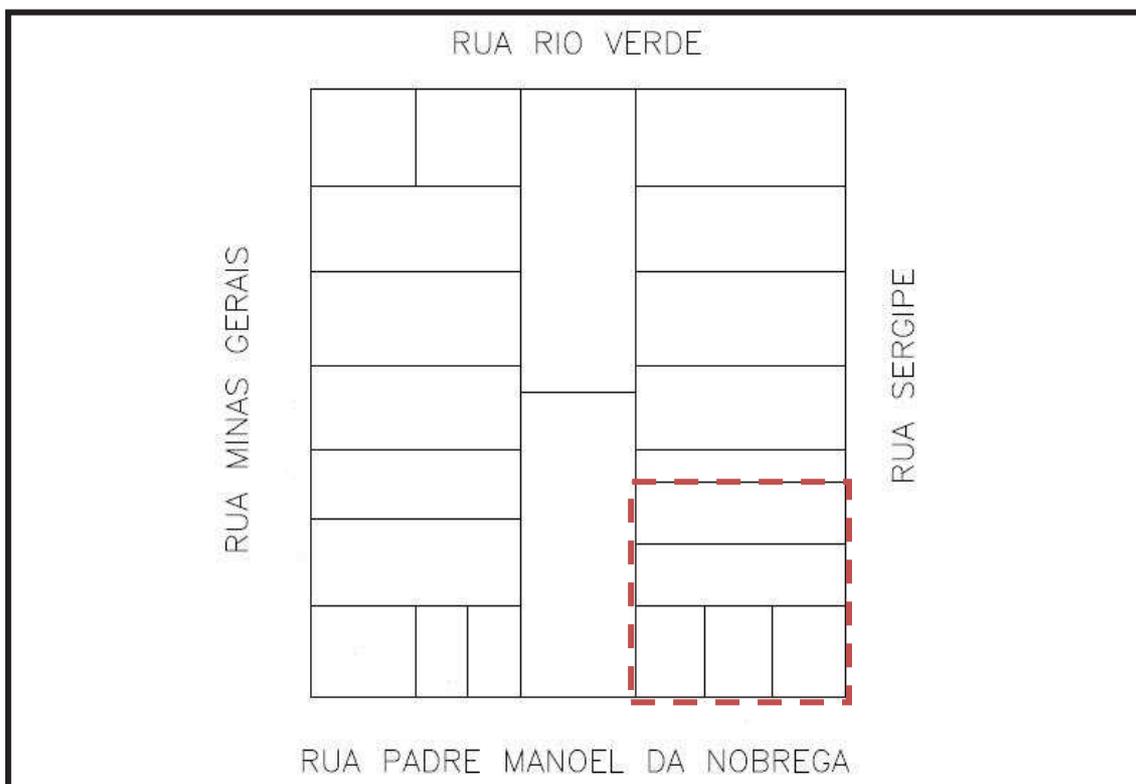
Planta baixa das quadras do local 01. FONTE: Junior Cesar Felix.
